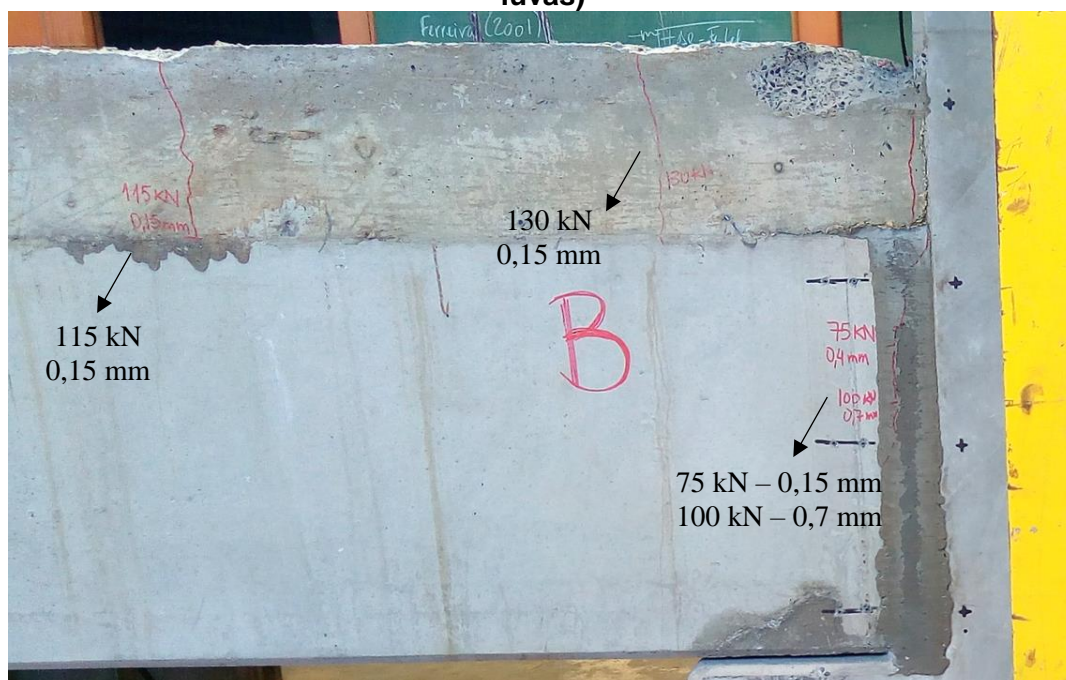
Detalhe 1 - Abertura de fissura na junta viga-pilar da viga B
